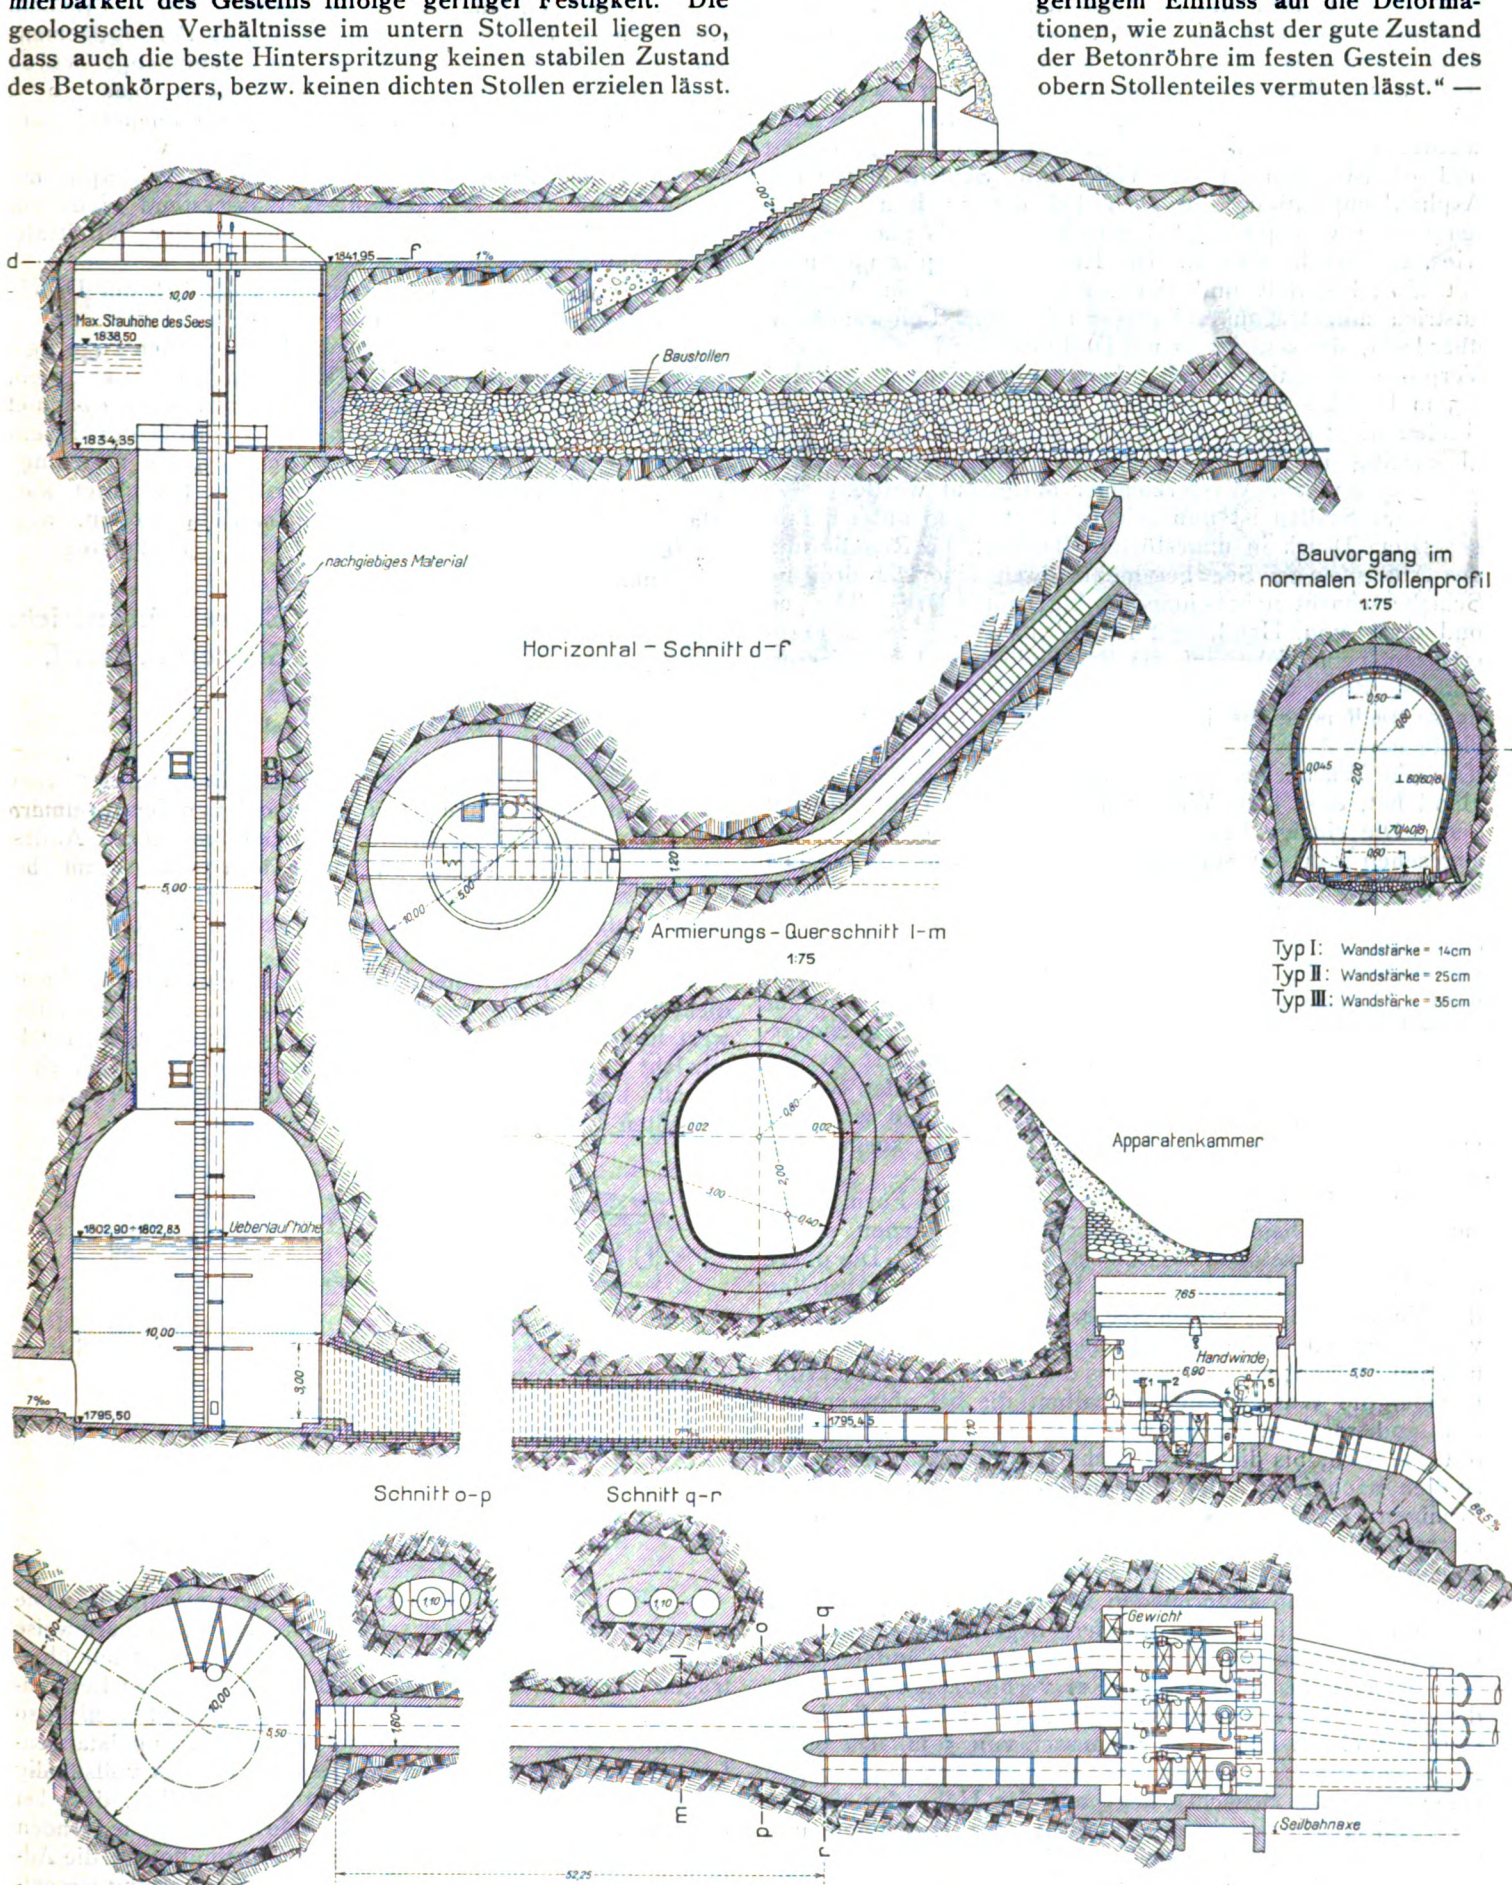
Wasserschloss und Apparatenkammer am Stollenausgang, Grundriss und Schnitte 1:300. — Stollenquerschnitte 1:75.
